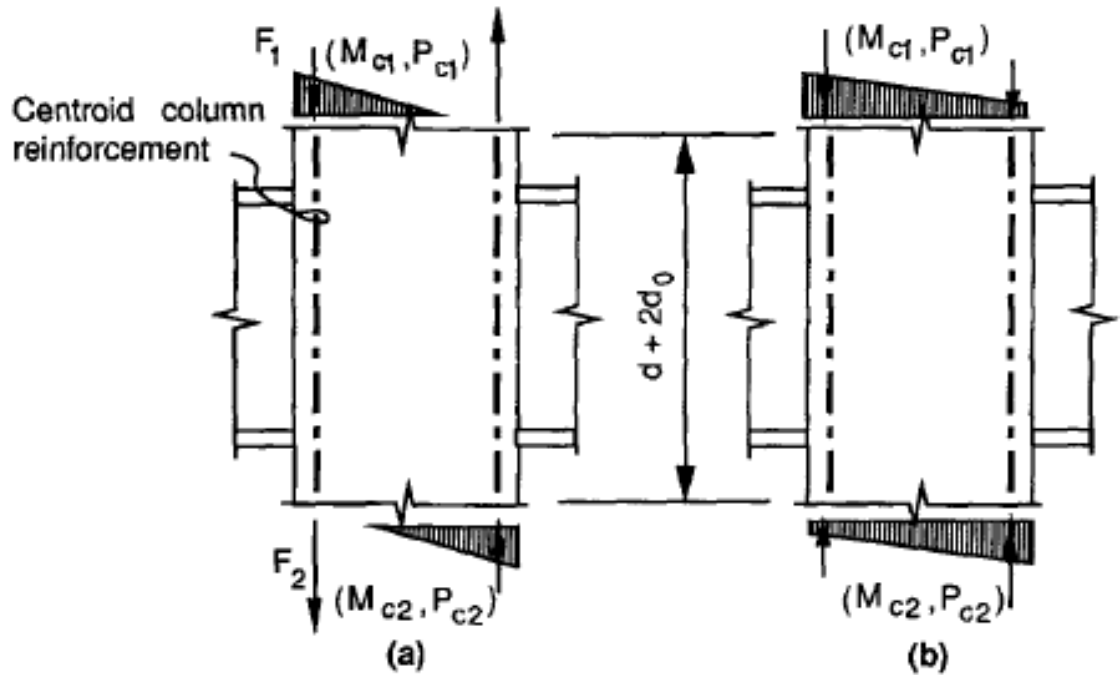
Fuerzas en el refuerzo longitudinal: (a) Bajas cargas axiales, (b) Elevadas cargas axiales. Nota: Datos tomados de la revista de Ingeniería Estructural (Journal of Structural Engineering) Vol. 120, N°8 (1994)
